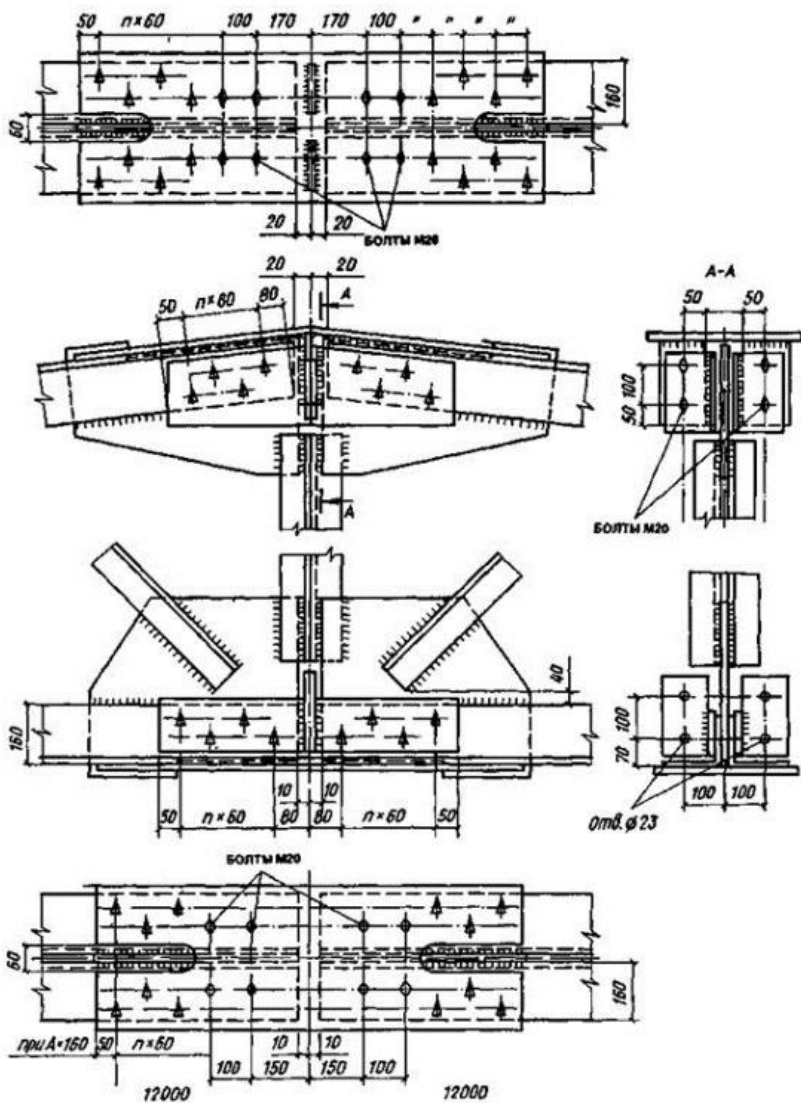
Укрупнительный стык стропильной фермы из парных уголков
